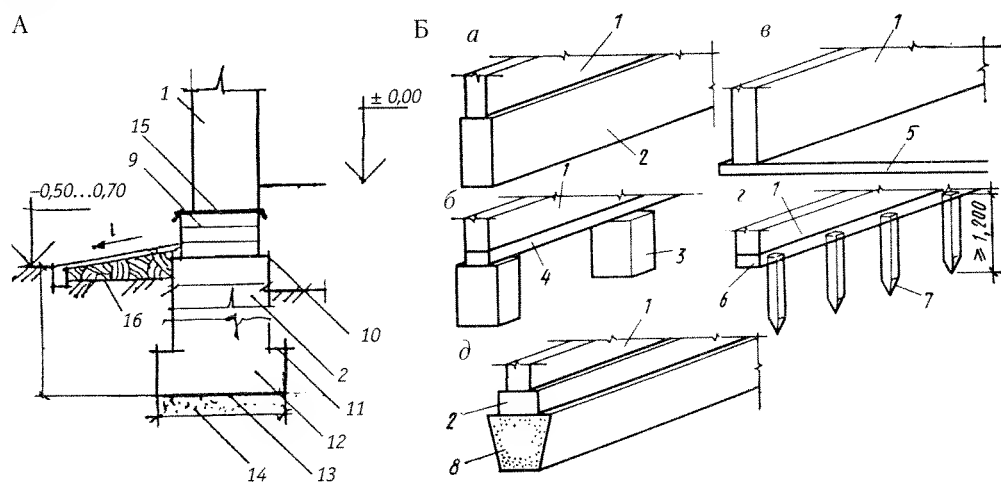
Схемы фундаментов: А – общий вид; Б – конструктивные схемы фундаментов малоэтажных жилых зданий:
